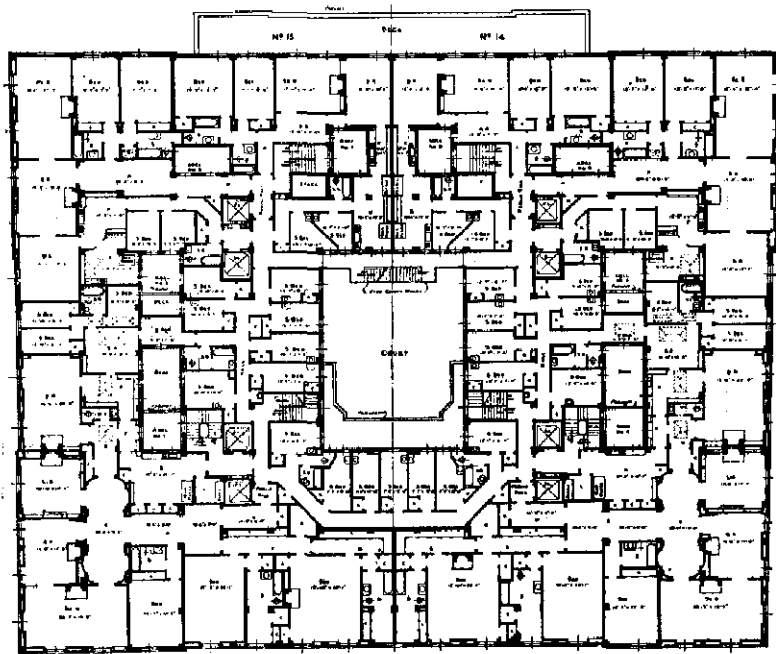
/ Devonshire House, Piccadilly, London / Grundriß des 1. Geschosses 1:600
